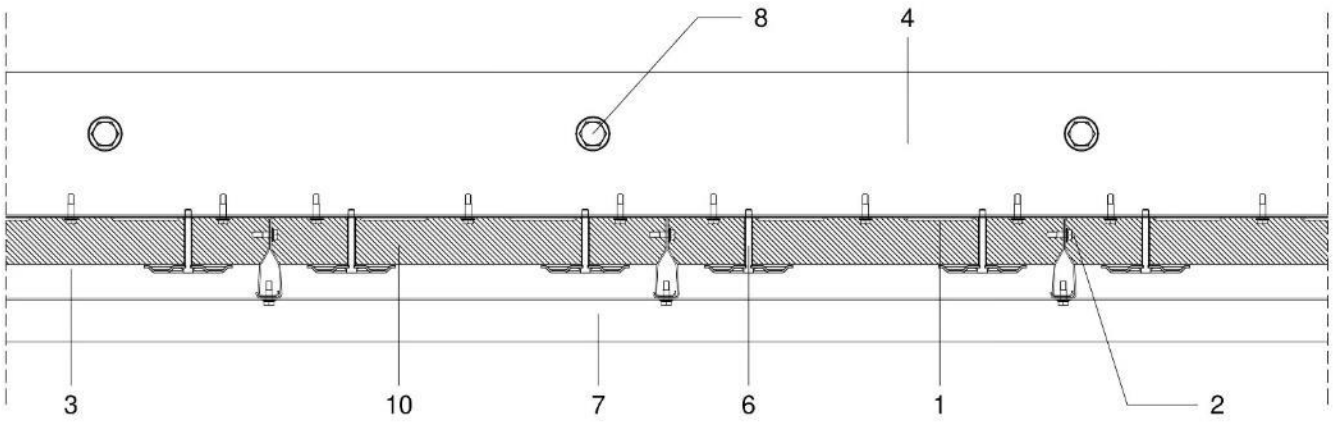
d: Sección horizontal con aislamiento y revestimiento de chapa Atenea en horizontal.
